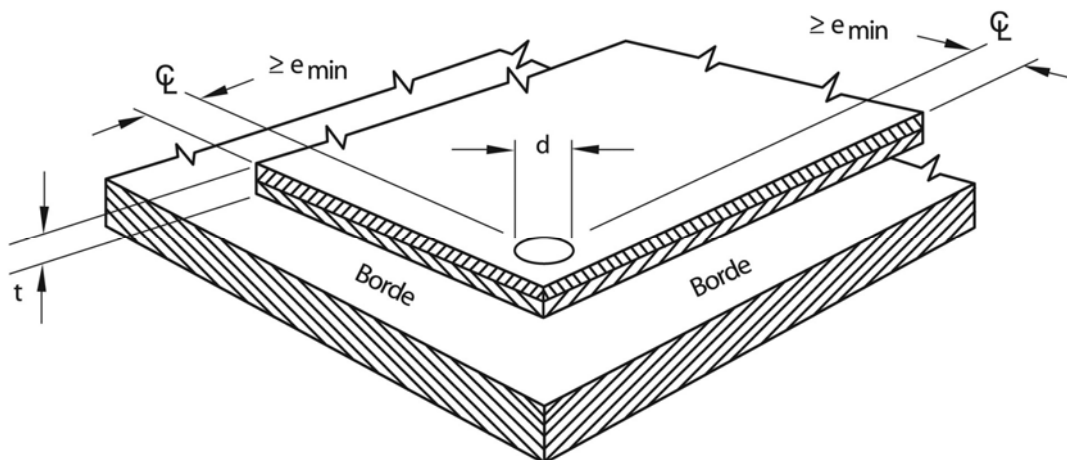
Distancia al borde para soldaduras de tapón — doble lámina
